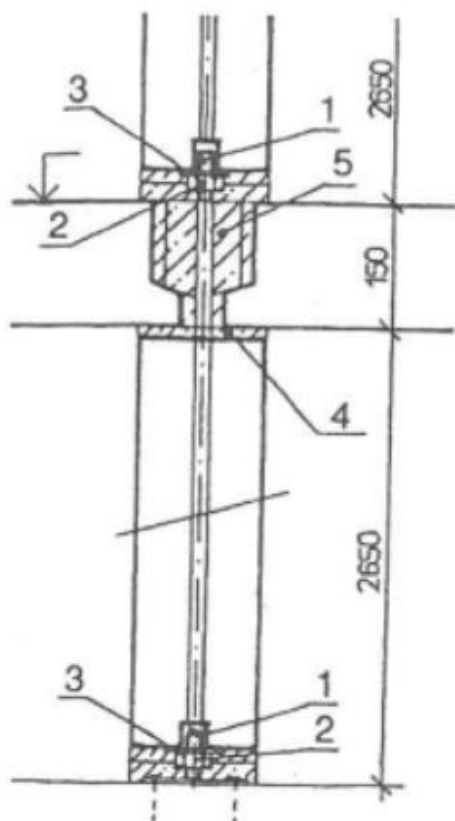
Zajištění spolupůsobení prefabrikovaných dílců
